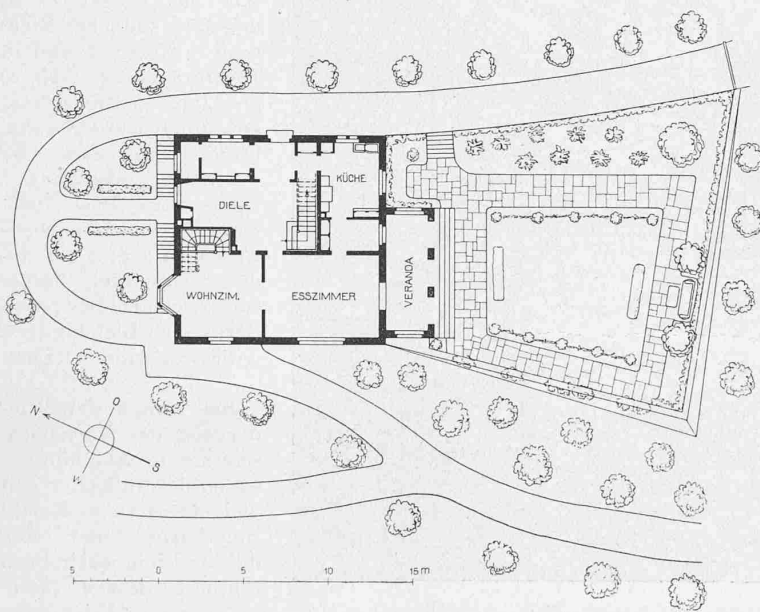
Lageplan und Erdgeschoss-Grundriss des Hauses Pochon. — 1 : 400.
